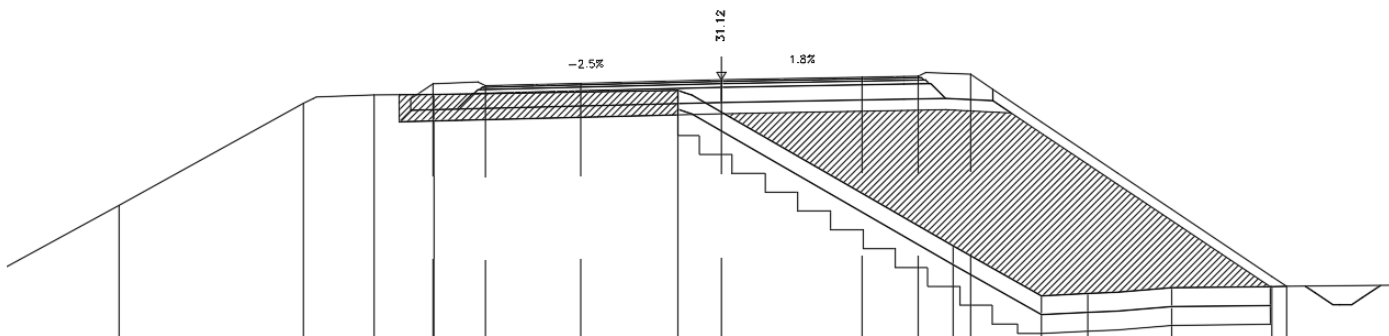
Sezione B2 del rilevato di appoggio alla spalla B, tra pk 1+140 e pk 1+200
